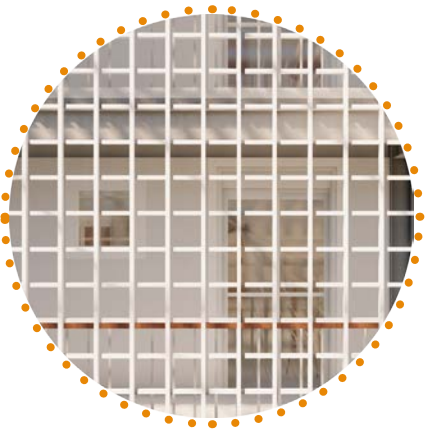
Vista da fachada nordeste, a partir do novo calçadão.
